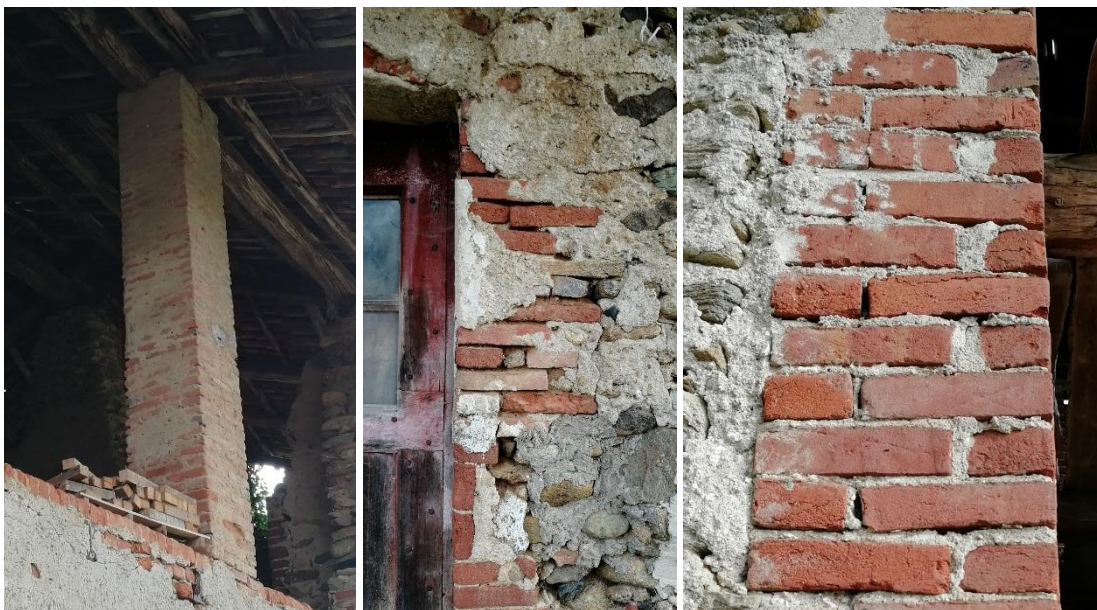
4.4 – 4.5 – Particolare muratura in ciottoli di pietra.
